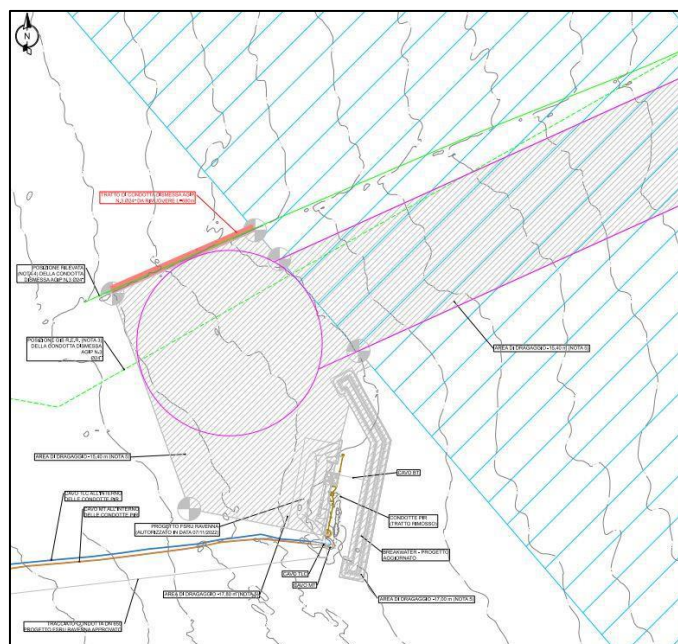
Stralcio planimetrico. In arancione il tratto di condotta da dismettere
